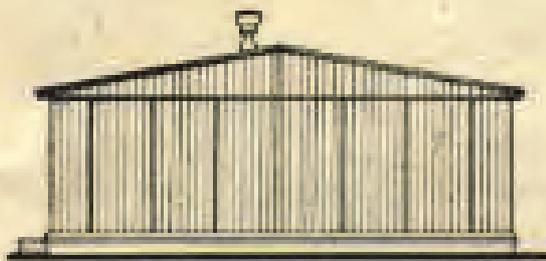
Baukastenbauweise des RAD-Holzhauses.
